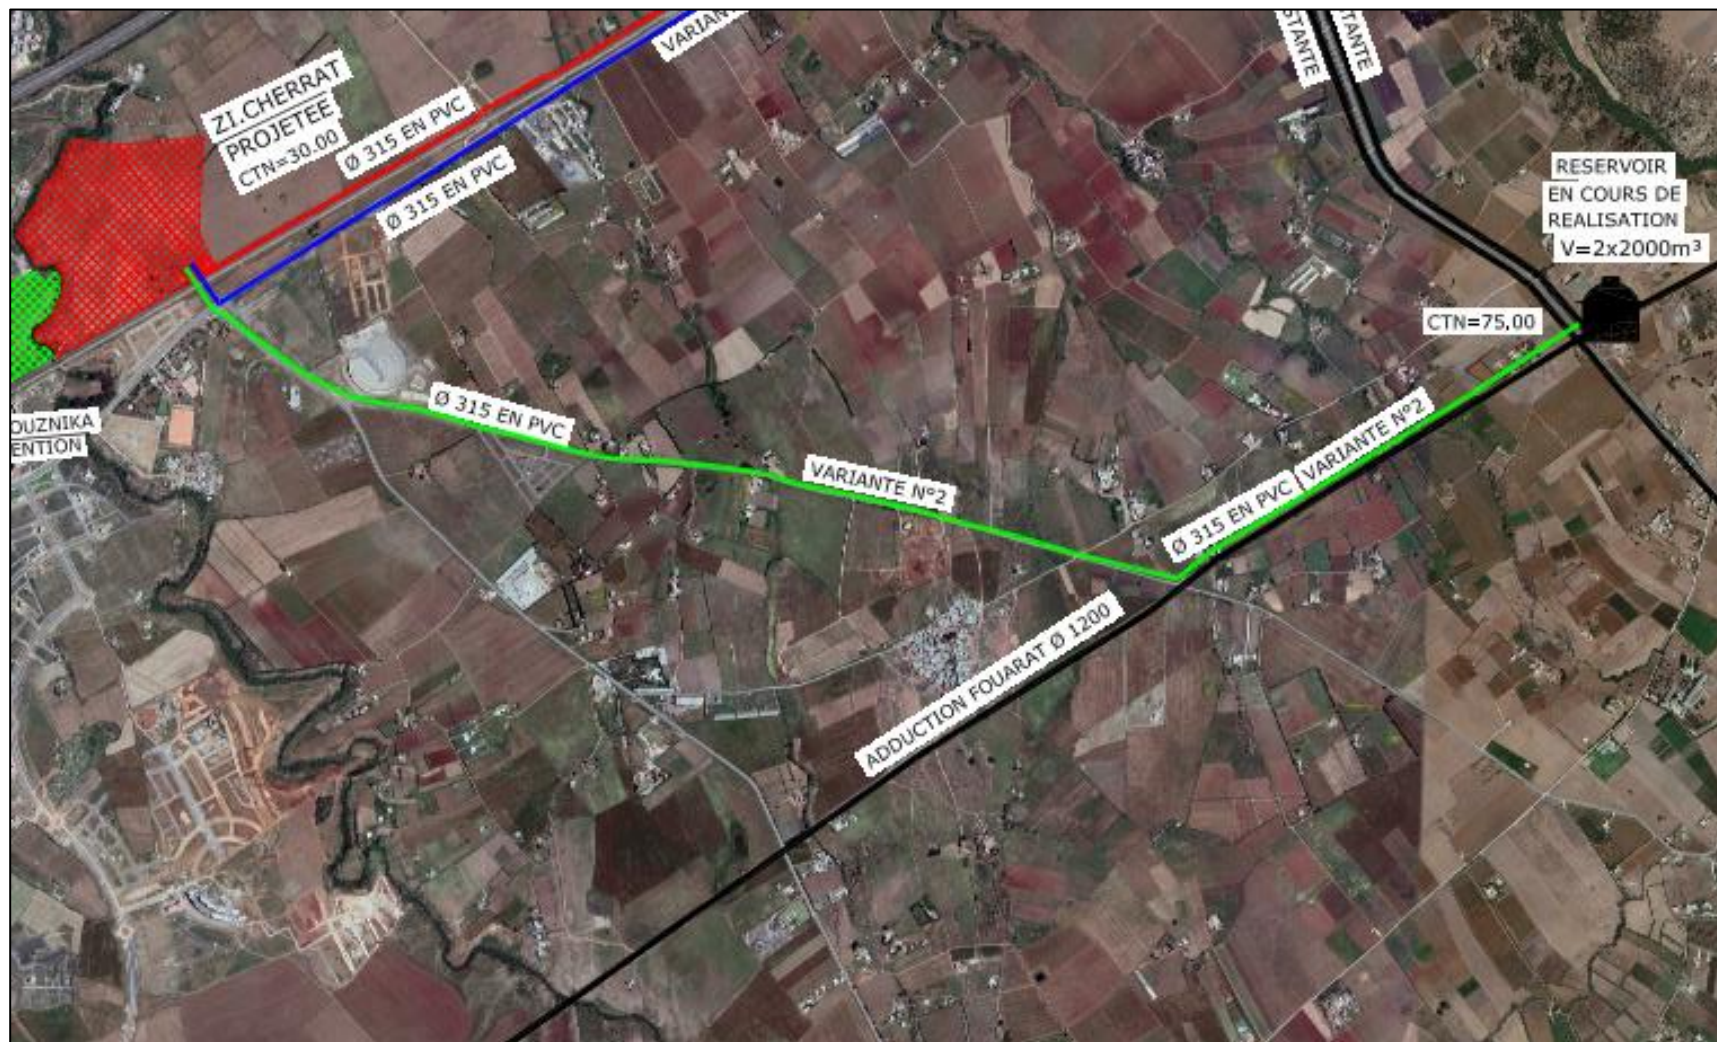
Vue en plan du réseau hors-site d'alimentation en eau potable de la zone du projet.
